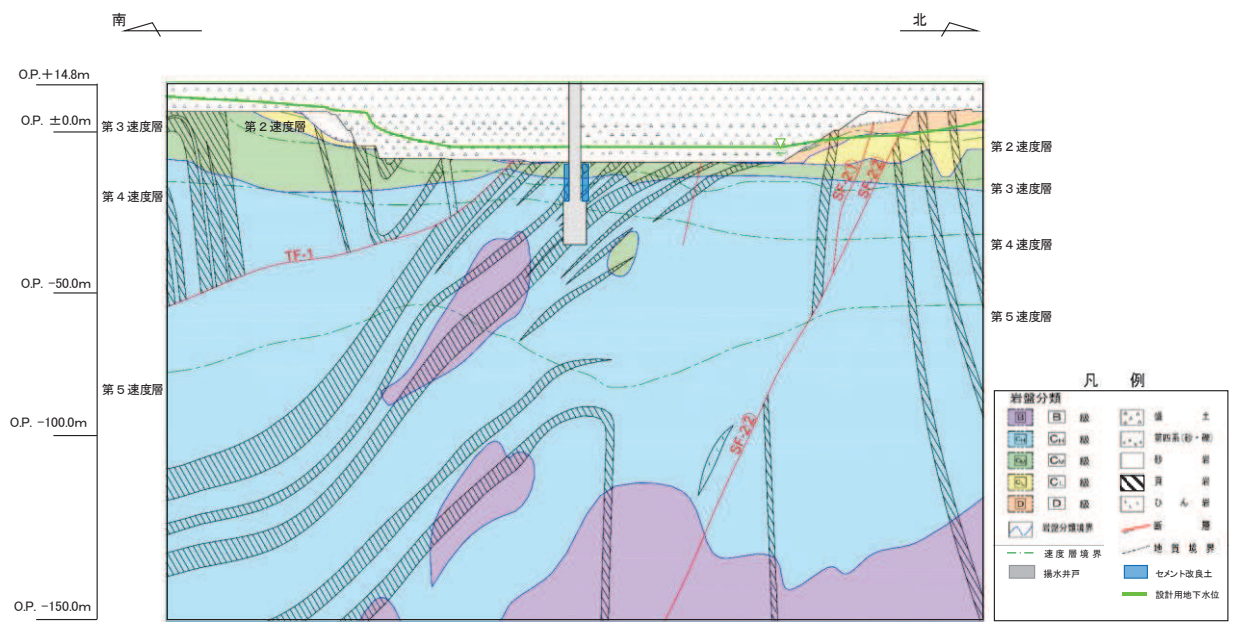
(2) No.2 揚水井戸 評価対象断面図 (B' -B 断面)
